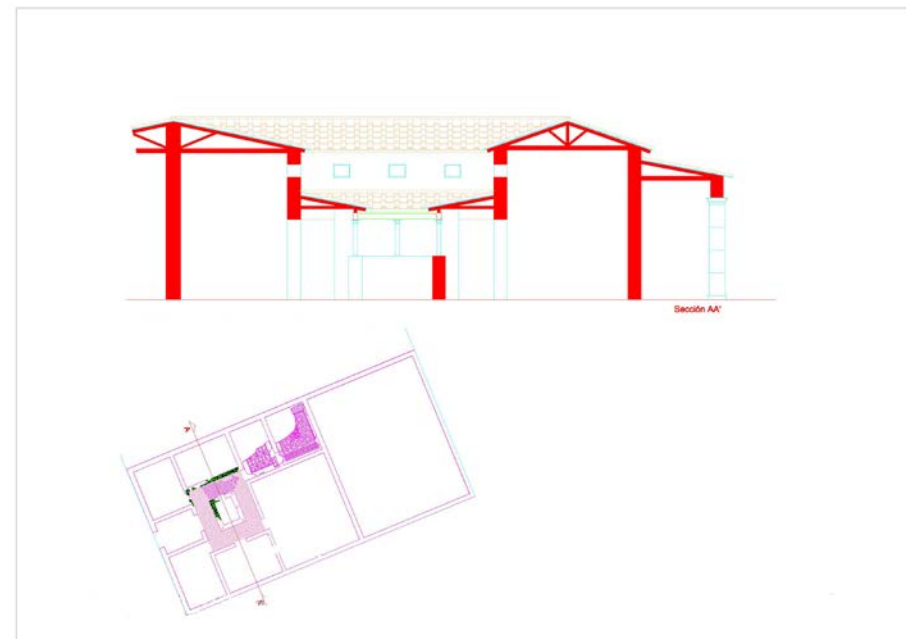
Interpretación de la planta y sección de la casa de Cupidos. Imagen, autora.
